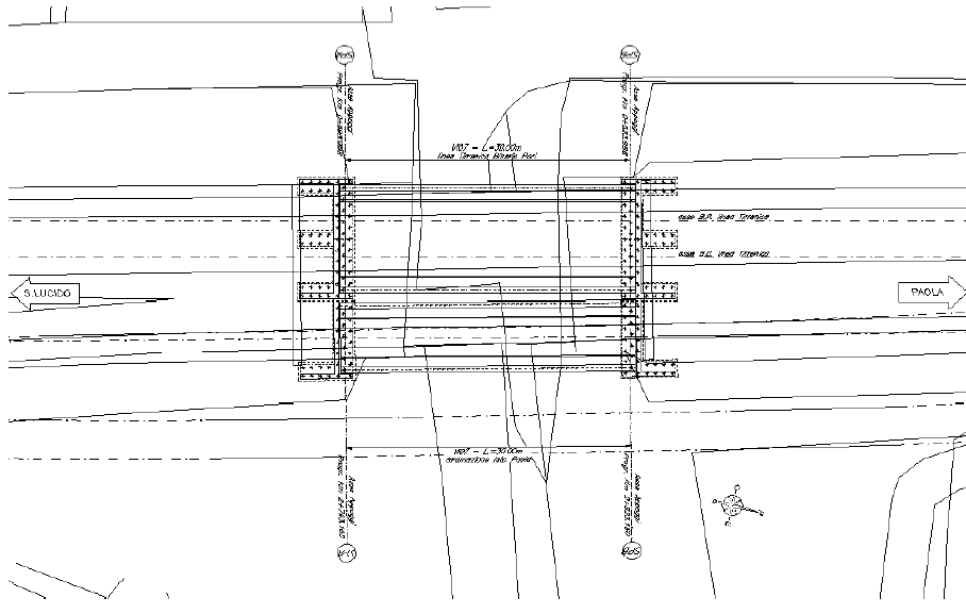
Planimetria dei viadotti ferroviari VI07a e VI07b
